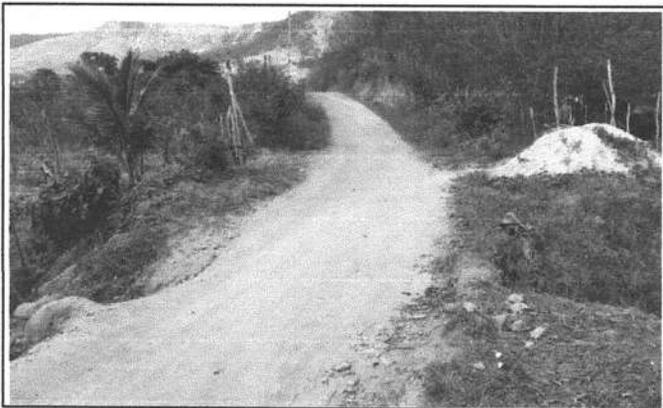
LOCAL DA CONSTRUÇÃO-BUEIRO
